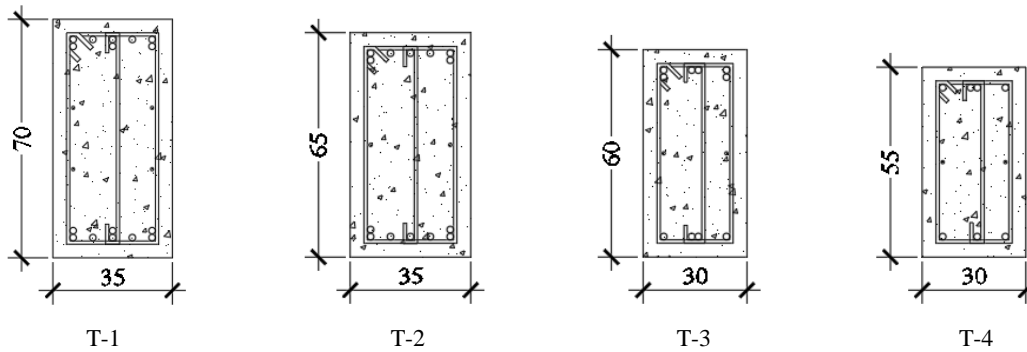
Secciones de traves del edificio de 10 niveles.
